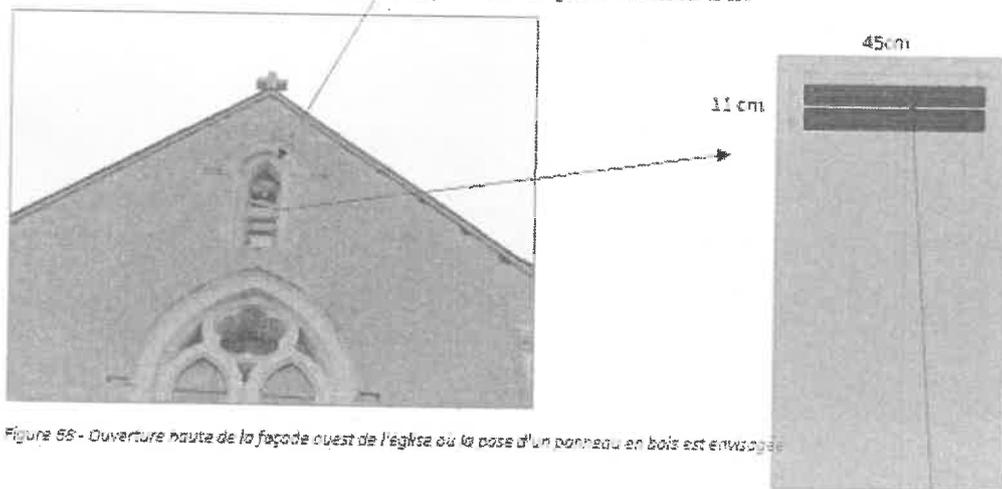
Ouverture haute de la façade ouest de l'église où la pose d'un panneau en bois est envisagée
